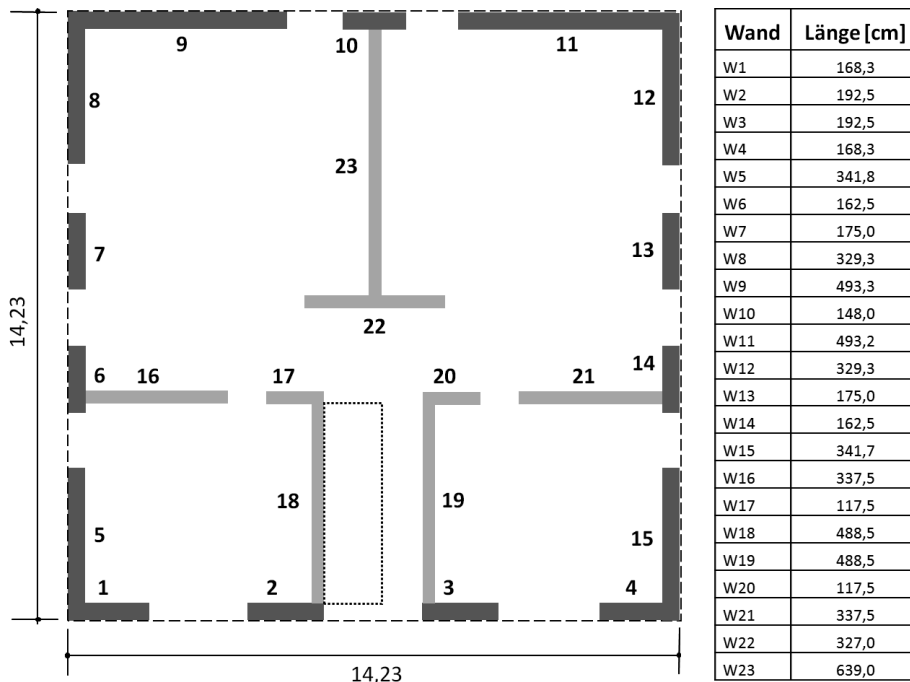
Grundriss des Mehrfamilienhauses
